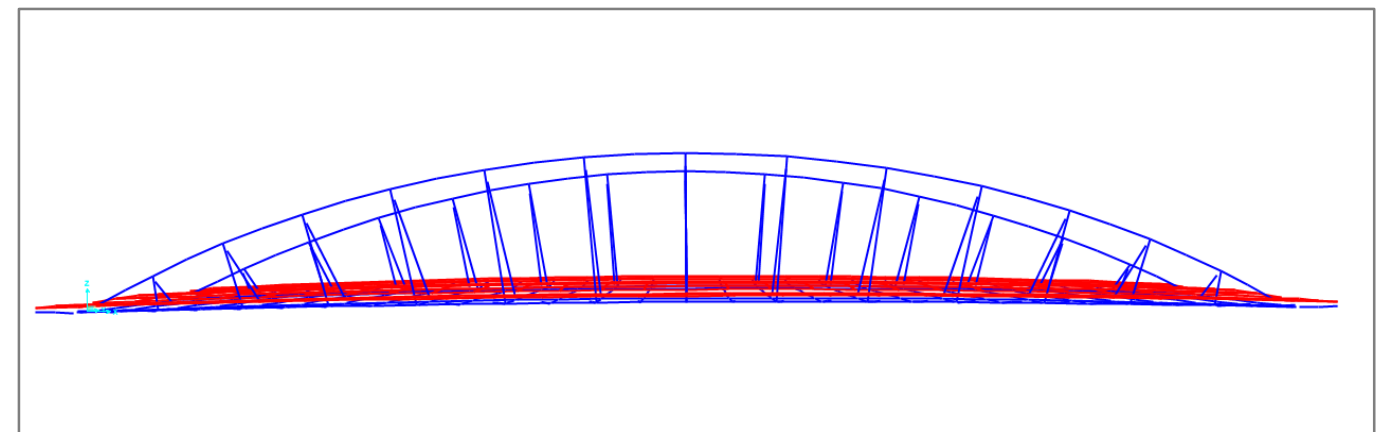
Alzado longitudinal del modelo estructural en SAP 2000
